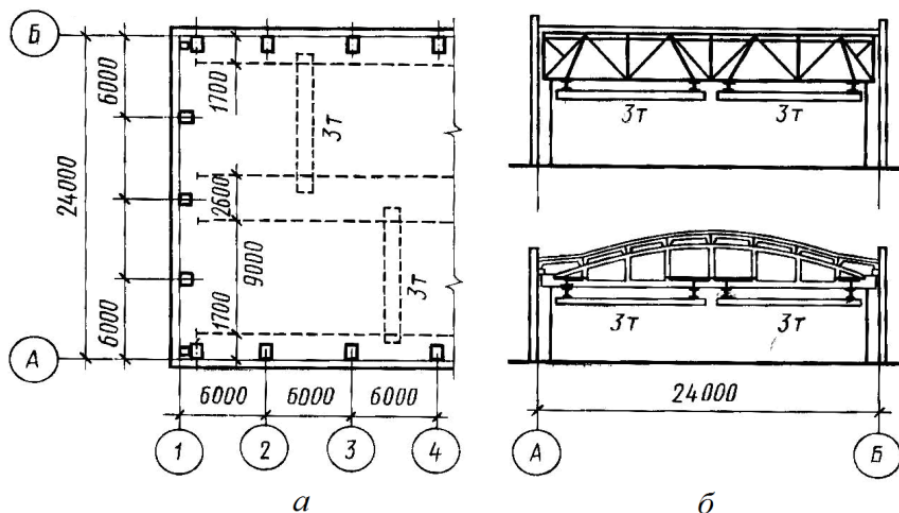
Одноэтажное промздание с подвесными кранами грузоподъемностью 3т: а — план; б — разрезы, показывающие расположение подвесных кранов в здании
